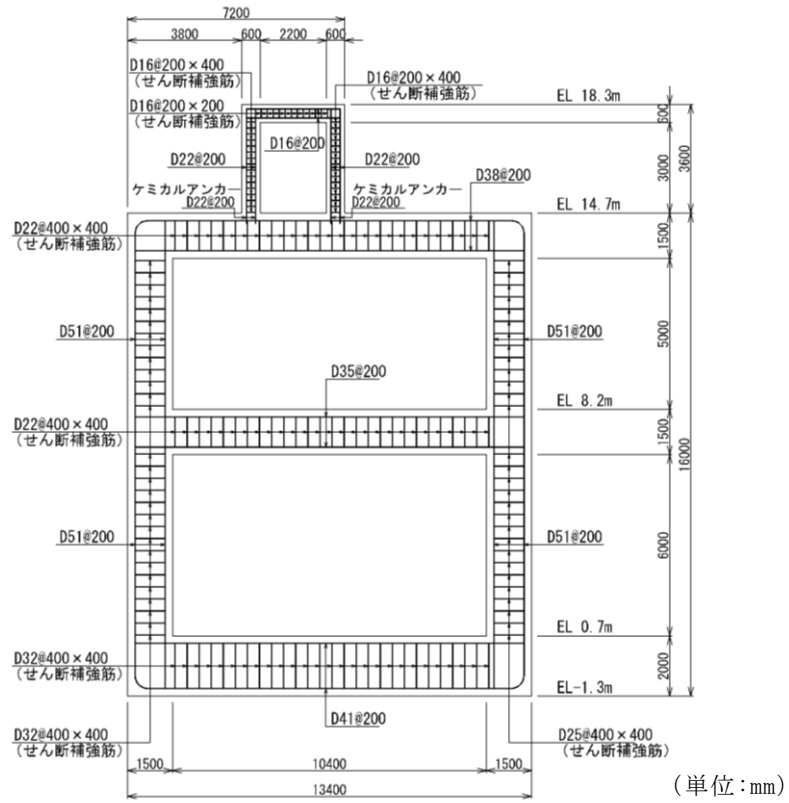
低圧原子炉代替注水ポンプ格納槽 概略配筋図 (A-A 断面)
